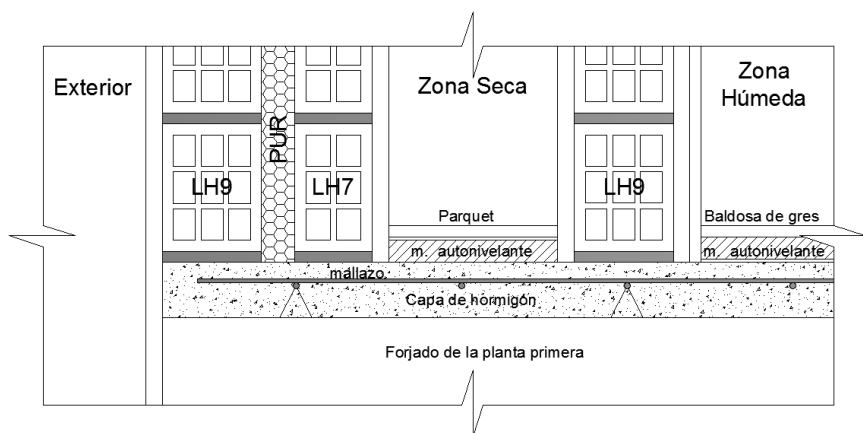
Detalle constructivo de las capas del suelo de la vivienda de la planta primera. 2014. Elaboración propia.
